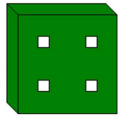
Détail d'encoffrement d'un poteau dans SAD
